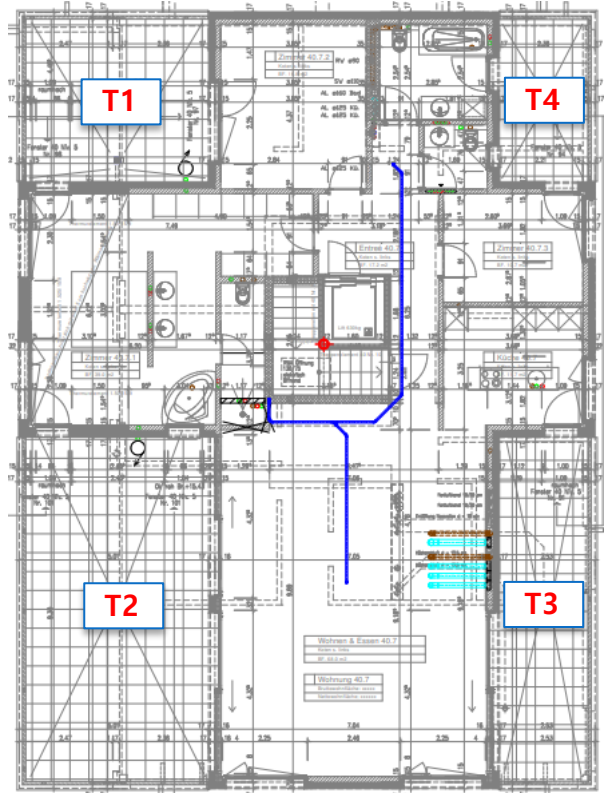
Haus 40 Dachgeschoss | Übersicht
